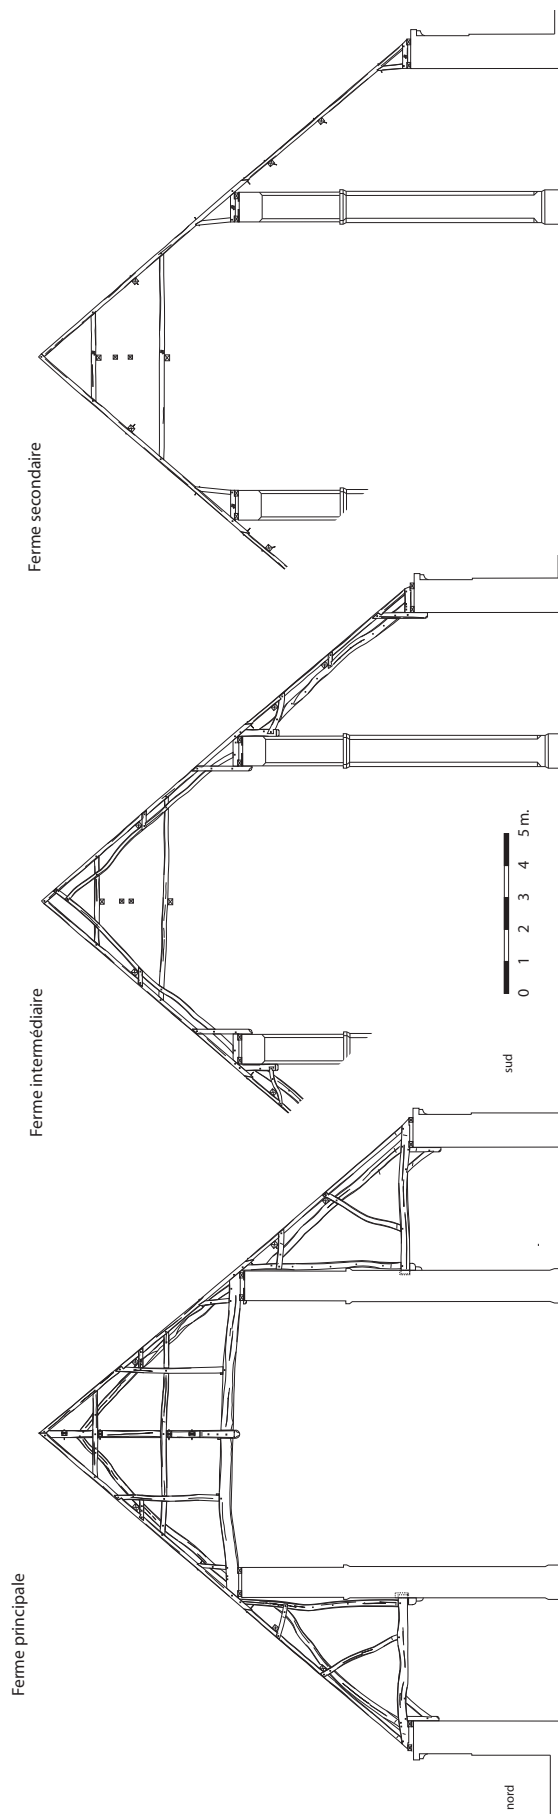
Saint-Lazare de Beauvais, fermes principale, intermédiaire et secondaire, 1219/1220d.
